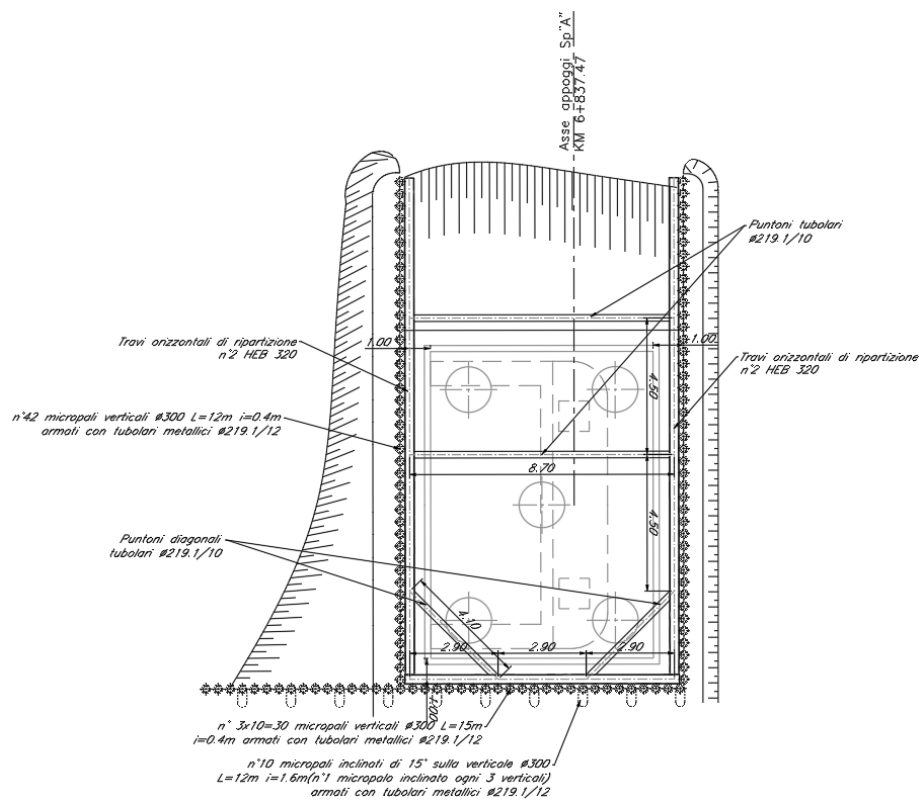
Pianta Opere Provvisionali Spalla A
